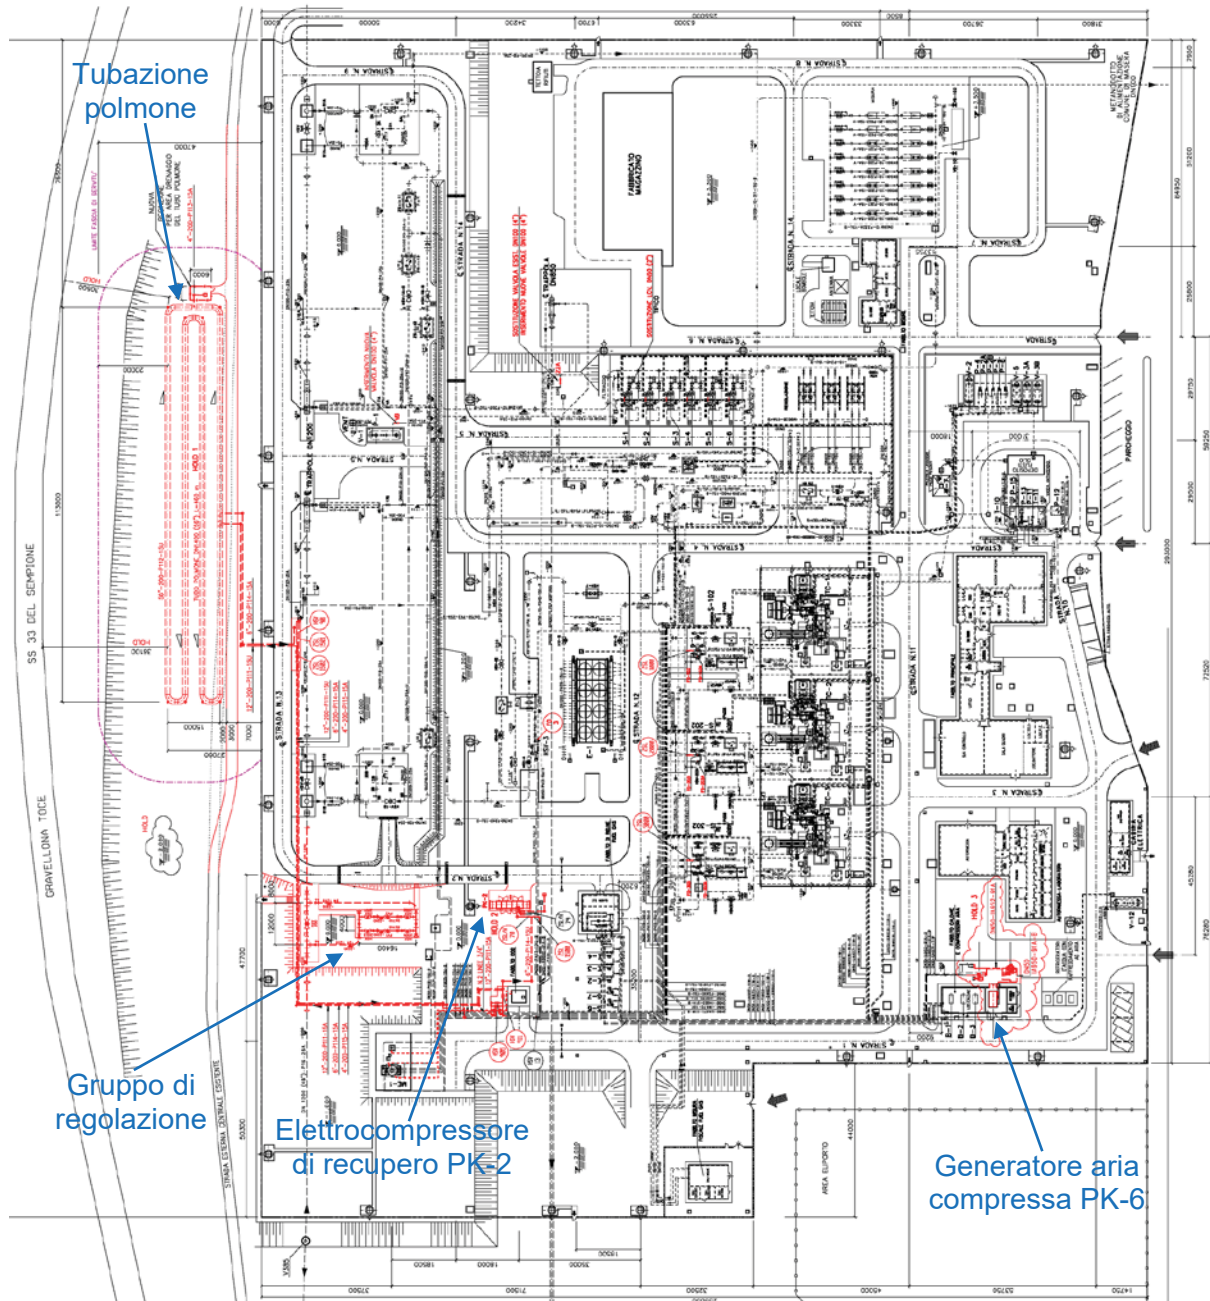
Planimetria dell'impianto, con evidenziazione (in rosso) delle apparecchiature oggetto di intervento
